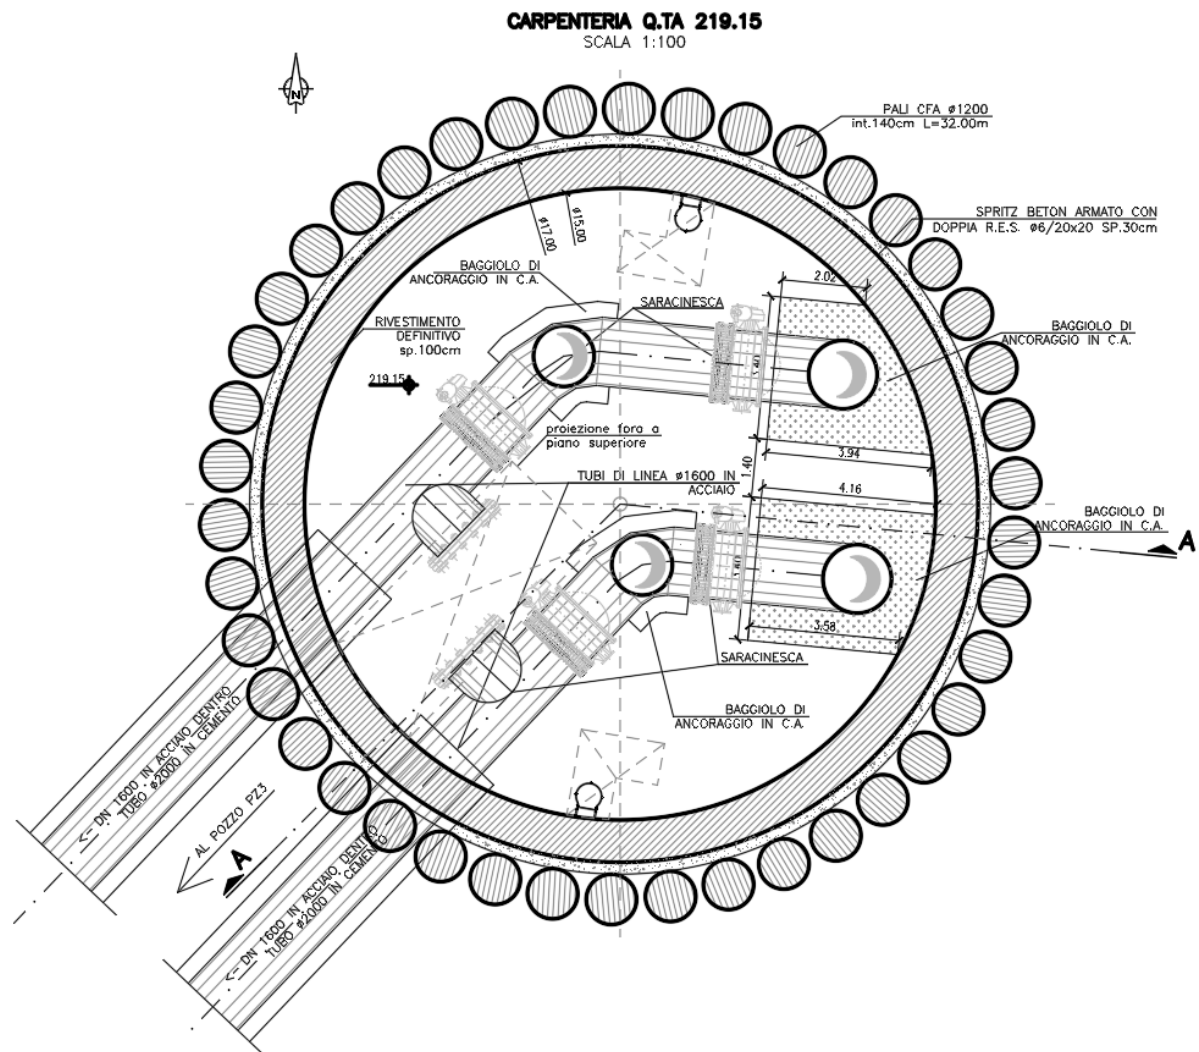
Rappresentazione in pianta del manufatto PZ2
